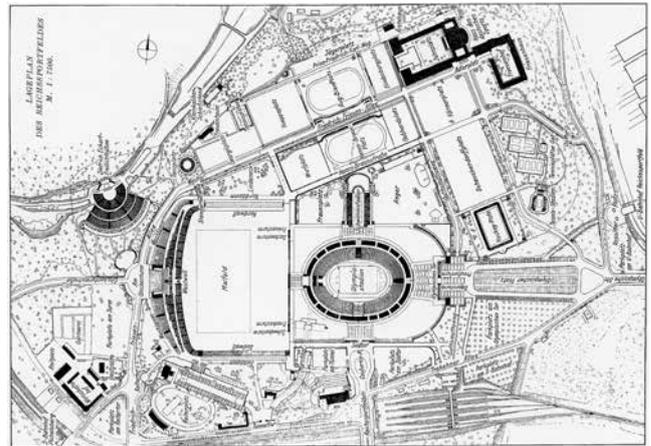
Berlin, Olympiagelände, Lageplan 1936
